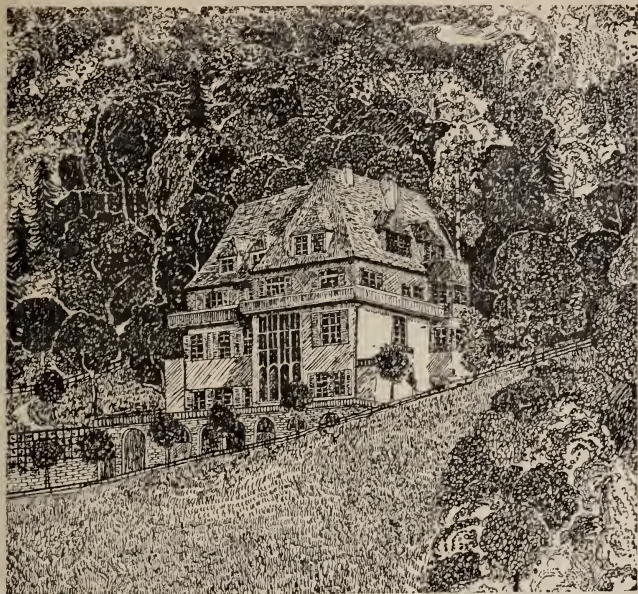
und 143. Landhaus an der Berglehne. Erdgeschoß mit Halle, Wirtschaftsräumen, Eßzimmer und Rauchzimmer
